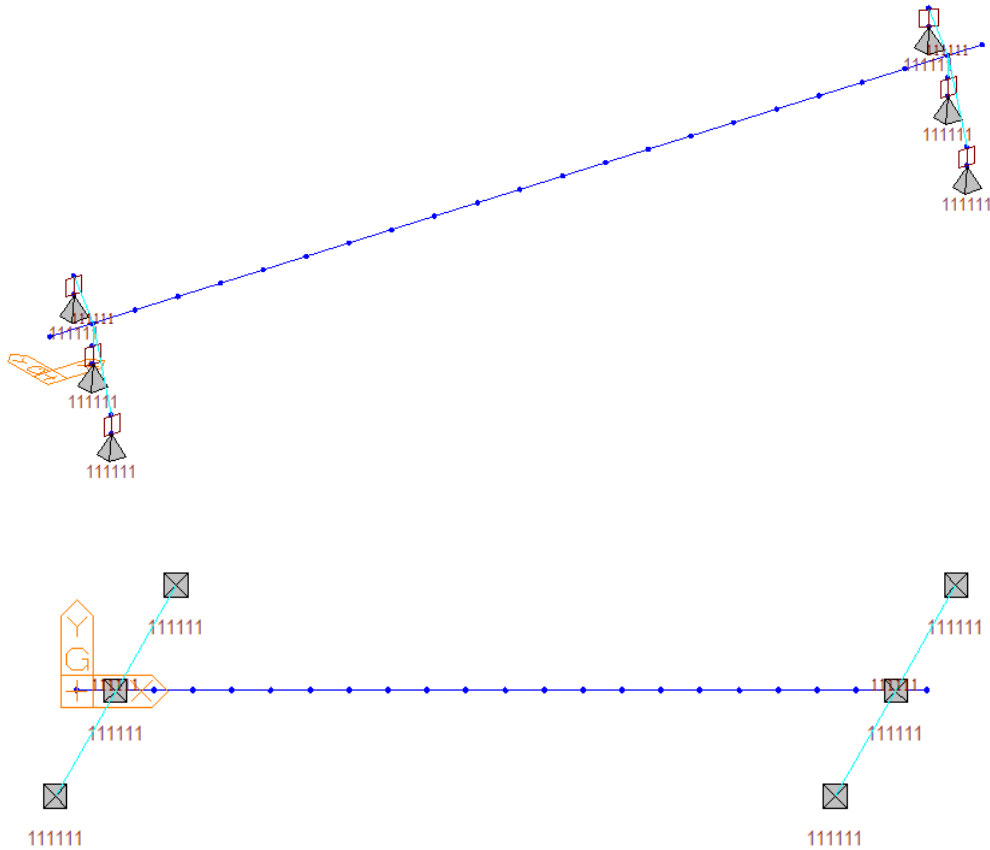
Vista 3D e vista in pianta del modello longitudinale
